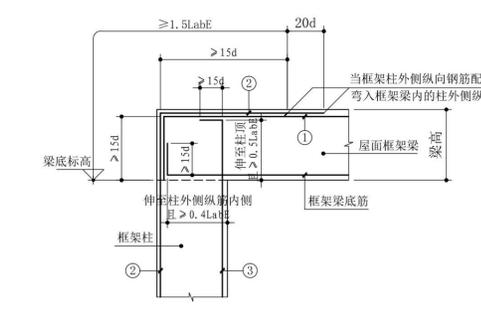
屋面框架梁纵向钢筋在顶层端支座构造大样
